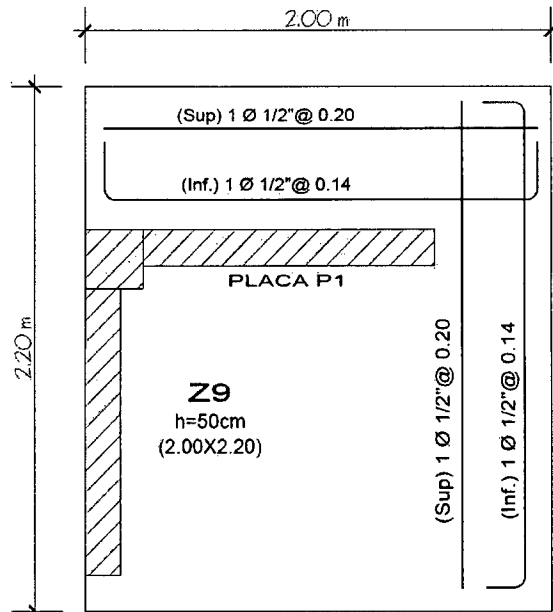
Distribución final del refuerzo para zapata Z-9.
